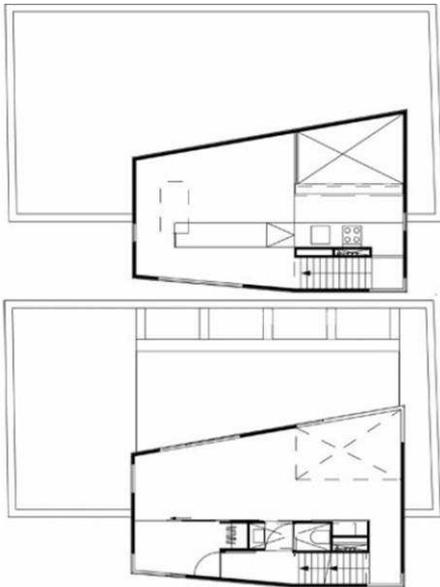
RUCKSACK HOUSE UBICACIÓN
